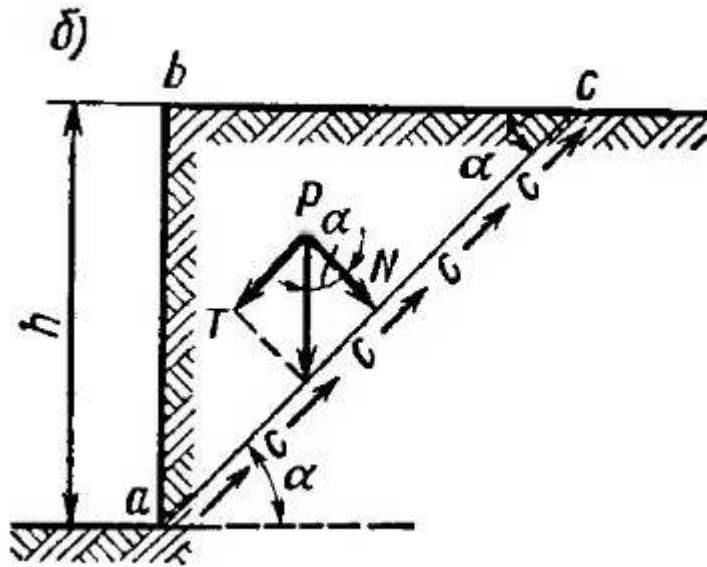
Расчетная схема откоса идеально связного грунта [7]
